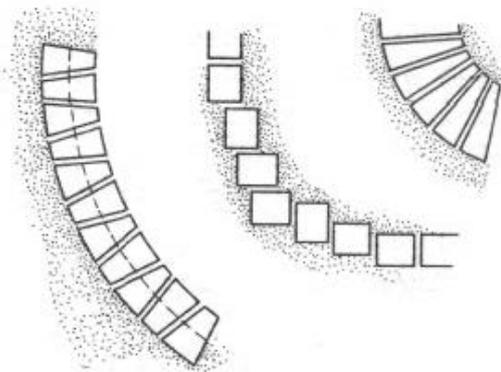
Укладка плит на углах и поворотах, вид сверху
